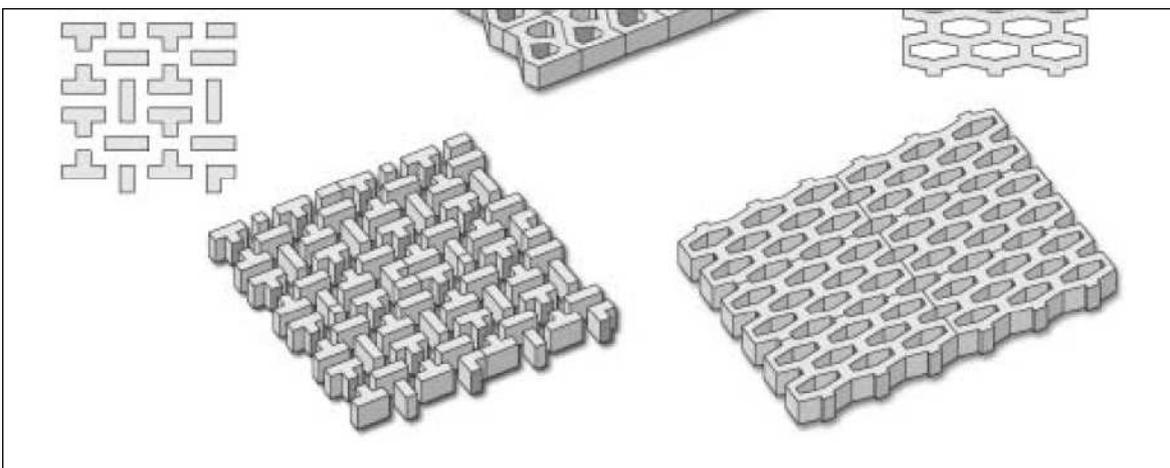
Tipologie di pavimentazione utilizzabili
